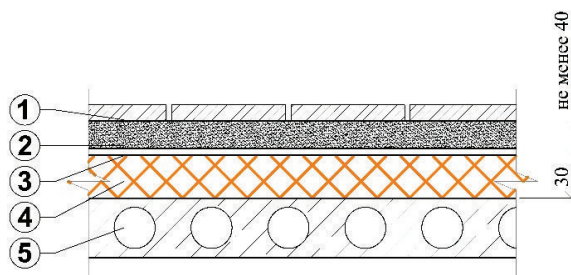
Принципиальная схема утепления пола по грунту в зданиях без подвала:
